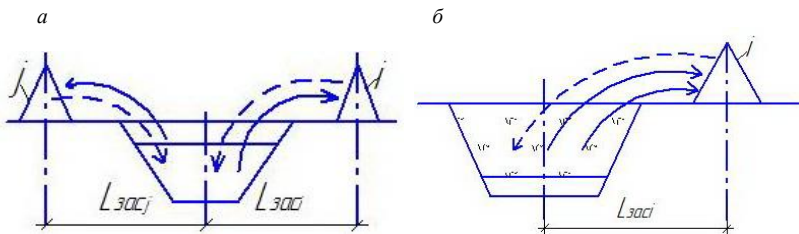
Схемы укладки грунтов в отвалы при устройстве пионерных траншей, подлежащих засыпке (ТС-2): *a* – на минеральных грунтах; *б* – на торфяных грунтах
